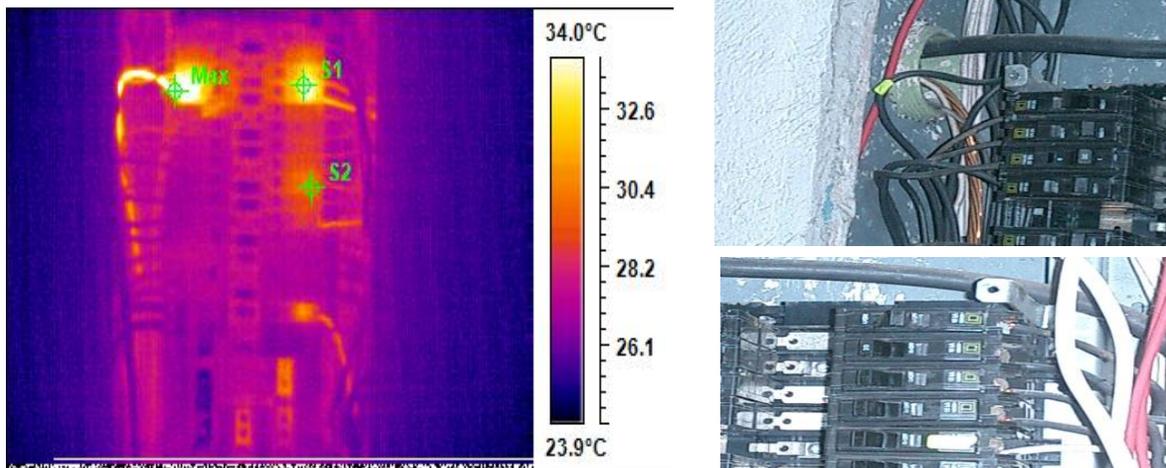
Interruptor Alimentación Planta Baja Edificio Docencia "A"
